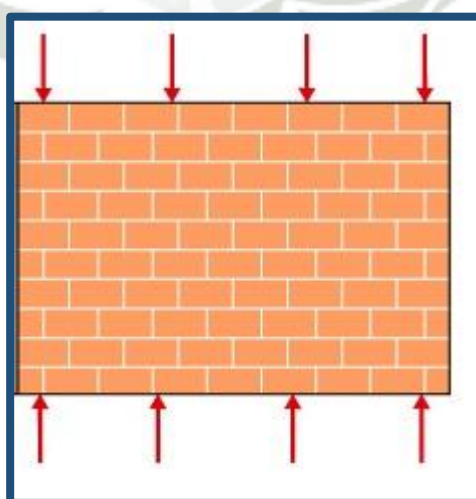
Fuerza de compresión perpendicular a la junta horizontal
